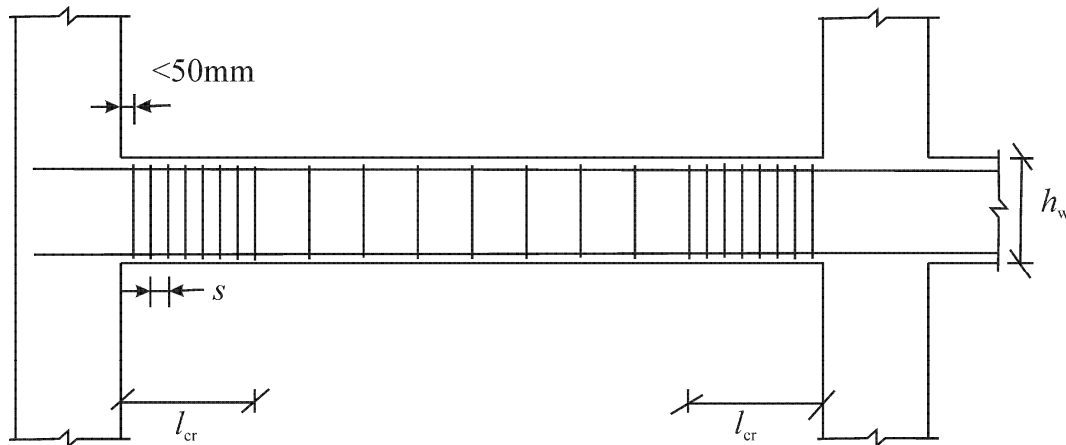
Disposition des armatures transversales de poutre. Les zones dissipatives ou « critiques » sont situées aux extrémités.
